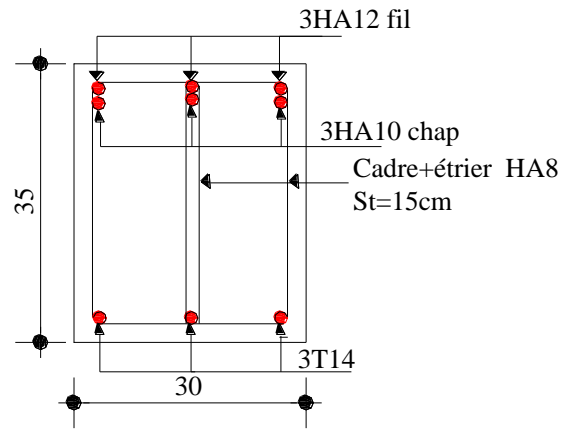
Schéma de ferrailage en travée de la poutre palière de l'escalier type2.
